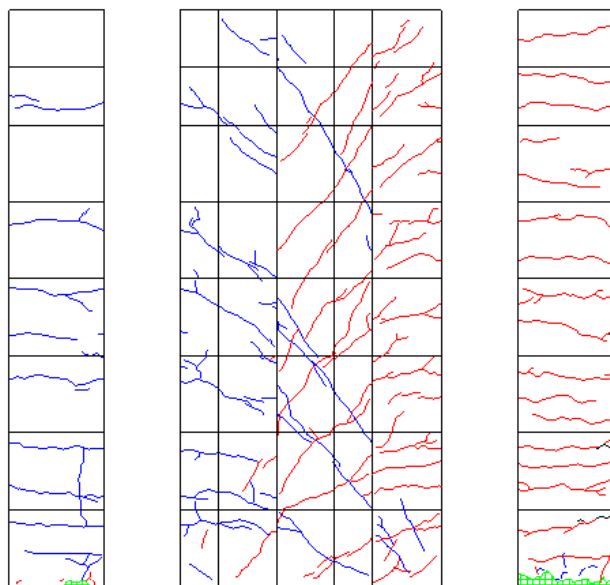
R=1/50②ひび割れ図
